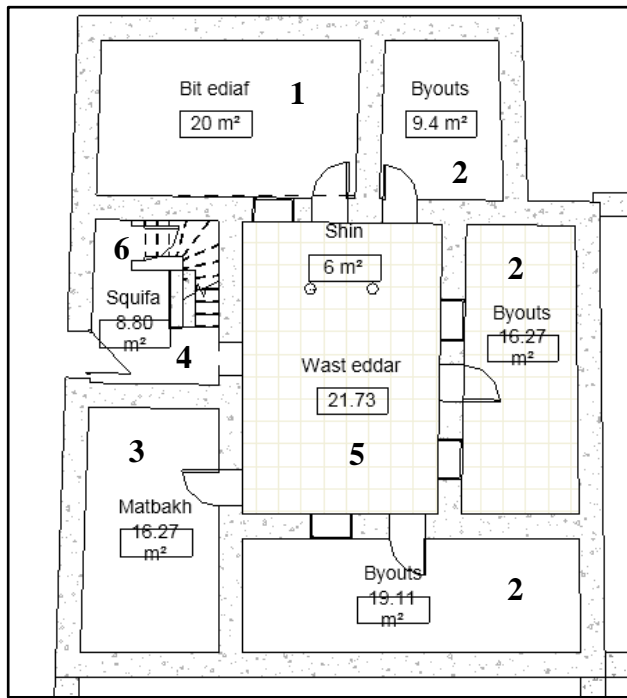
Plan de masses (Auteur) Figure III-15 Plan de masses (Auteur)
